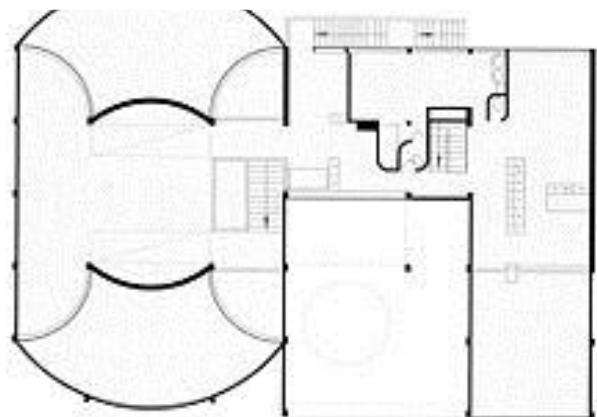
Pabellón de L'Esprit Nouveau. Segunda planta. Fuente: <http://www.urbipedia.org/>
